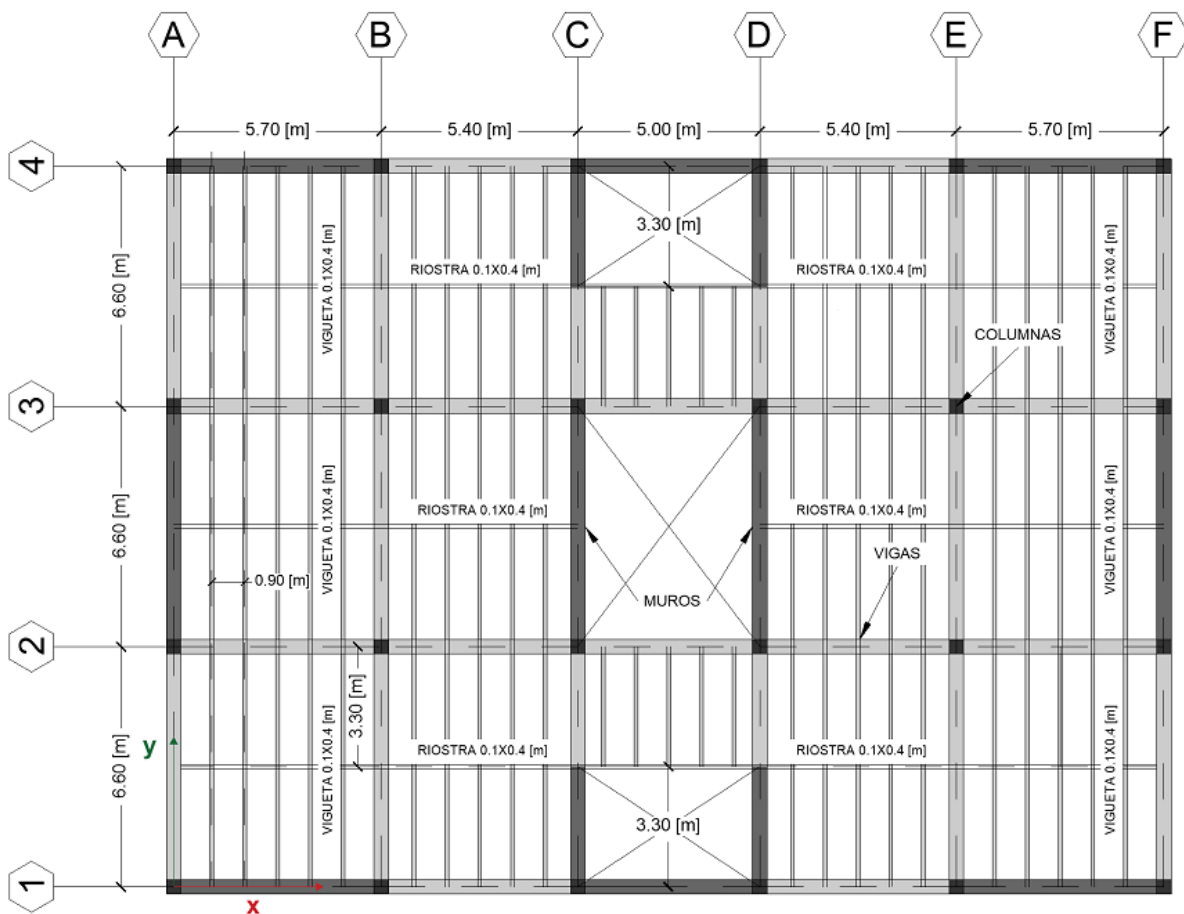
Planta tipo de los sistemas estructurales del modelado.
